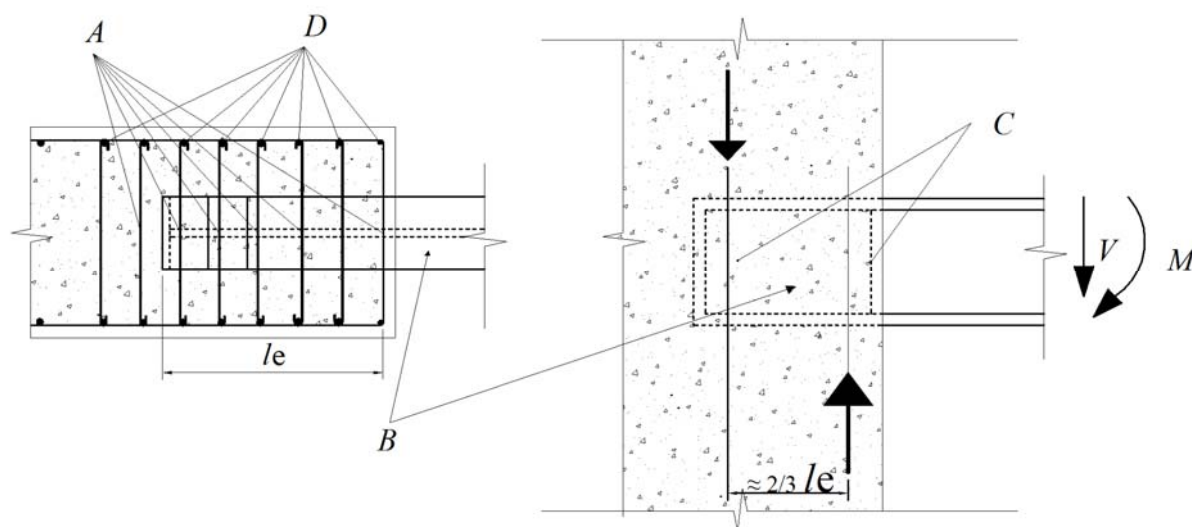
Dispositions constructives des éléments de rive mixtes partiellement enrobés (détail des armatures transversales pour la classe de ductilité DCH).
